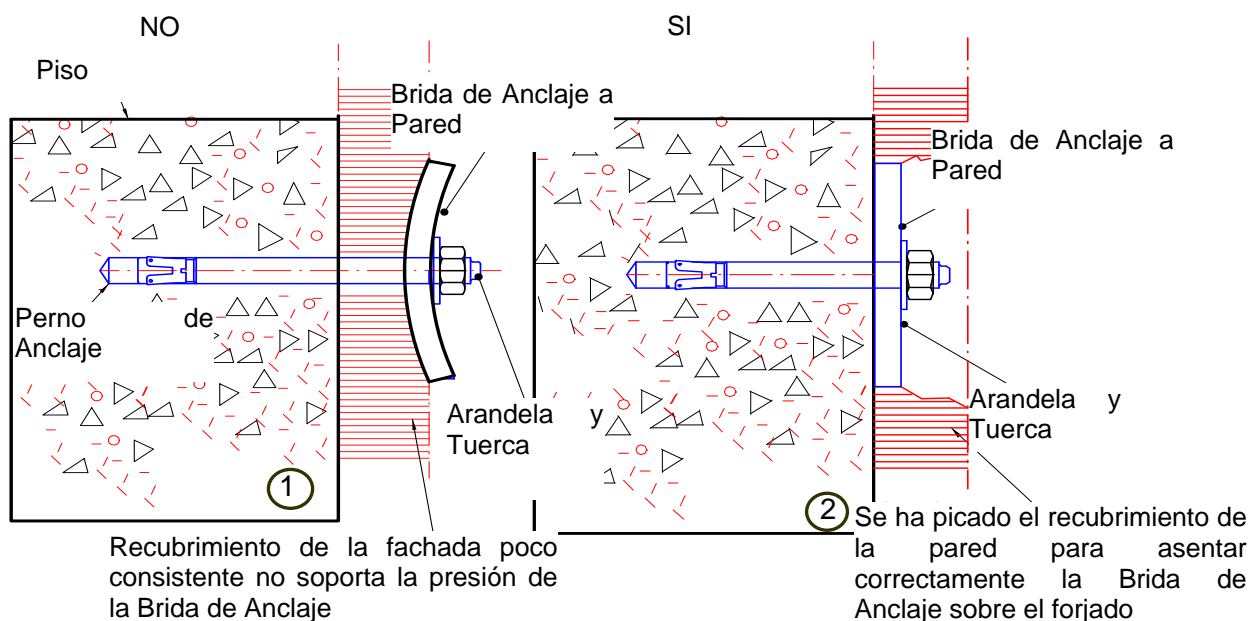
Montaje Borda Anclaje a Pared. Fachada con recubrimiento
